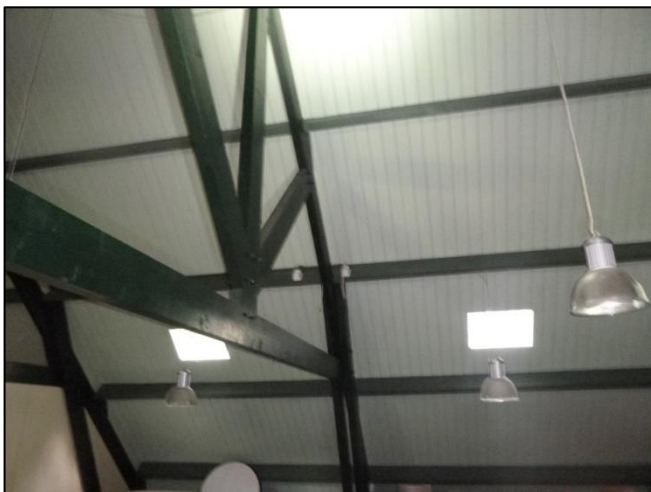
Vide: Dakbeschoot (Niet asbestverdacht)
